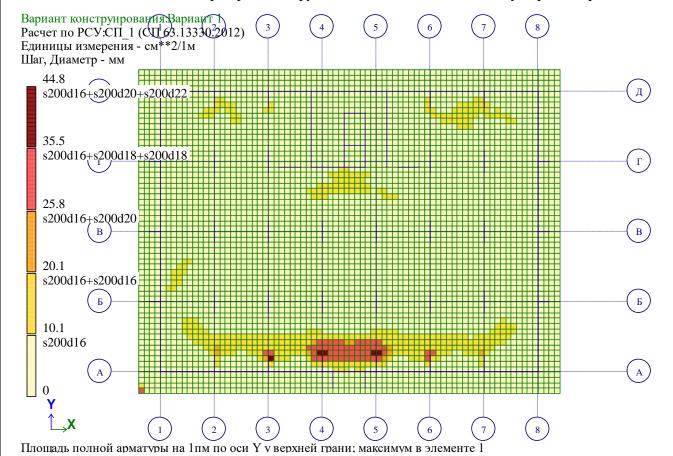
Расчетное армирование фундаментной плиты по оси Y у верхней грани.
